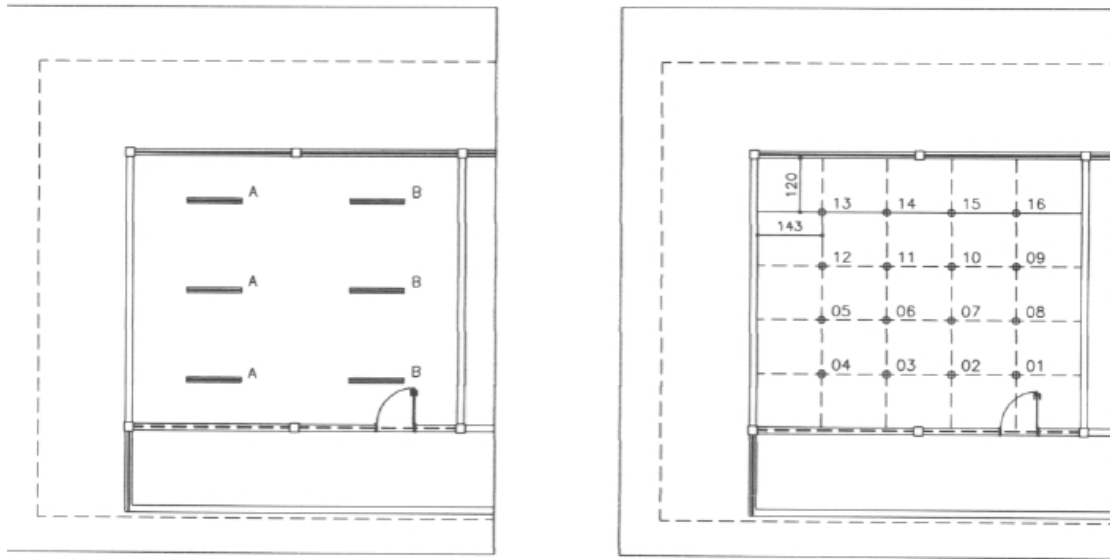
Planta Luminotécnica da sala 03 e localização dos pontos de medição.
